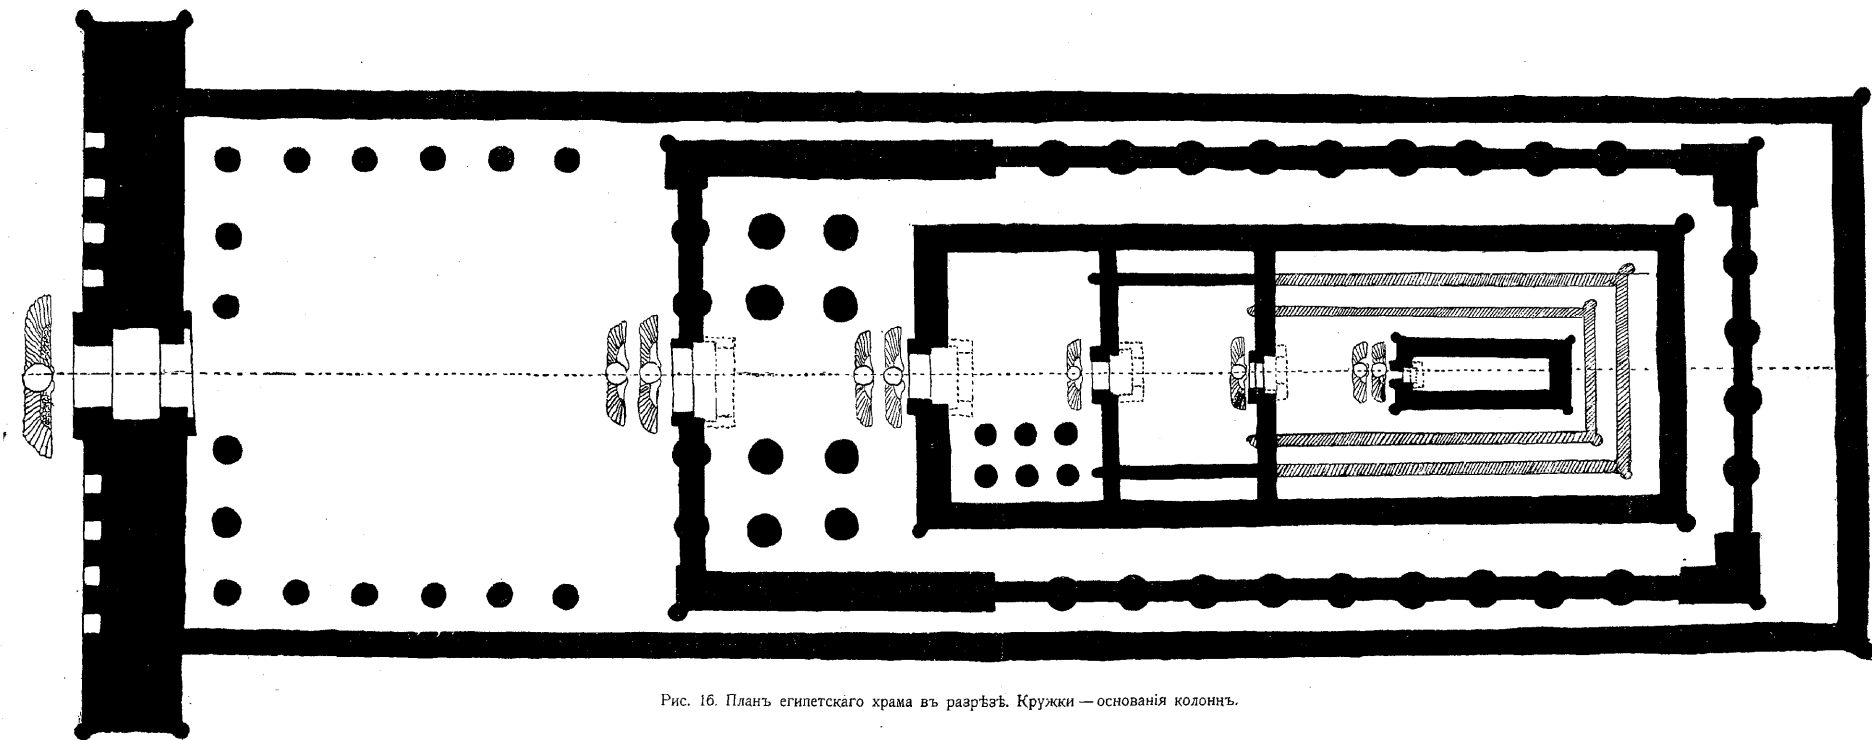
План египетскаго храма въ разрёзѣ. Кружки — основанія колоннъ.
